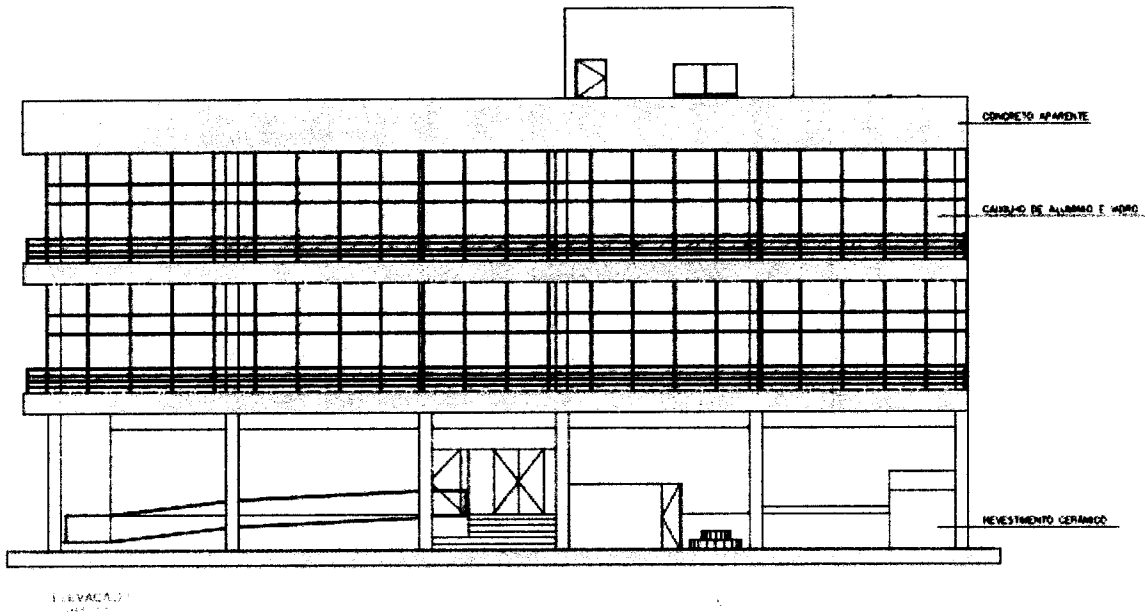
Elevação Frontal do Centro Cultural – Praça Monsenhor Roque Pinto
